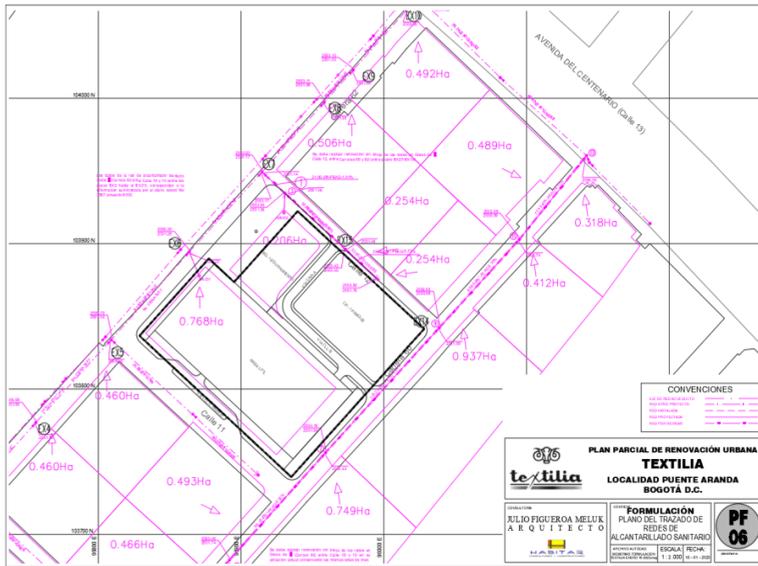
PF 06. Trazado de Redes de Alcantarillado Sanitario
